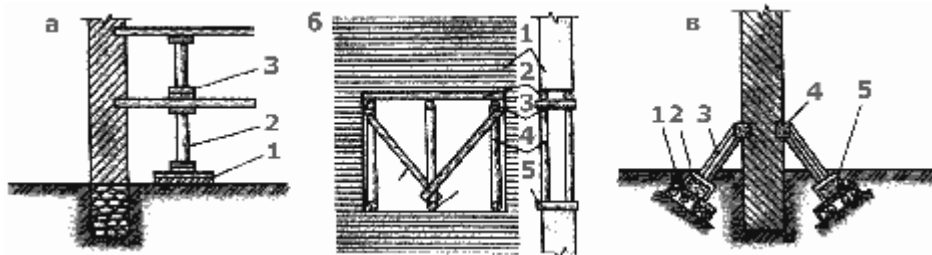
Способы разгрузки фундаментов: а - устройство временных опор; 1 - деревянная подушка; 2 - временные стойки; 3 - клинья; б - крепление проемов; 1 - стена; 2 - опорное бревно; 3 - насадка; 4 - стойка; 5 - подкладка; в - устройство раскосов; 1, 2 - деревянные подушки из брусьев; 3 - клинья; 4 - брус; 5 - скоба.
